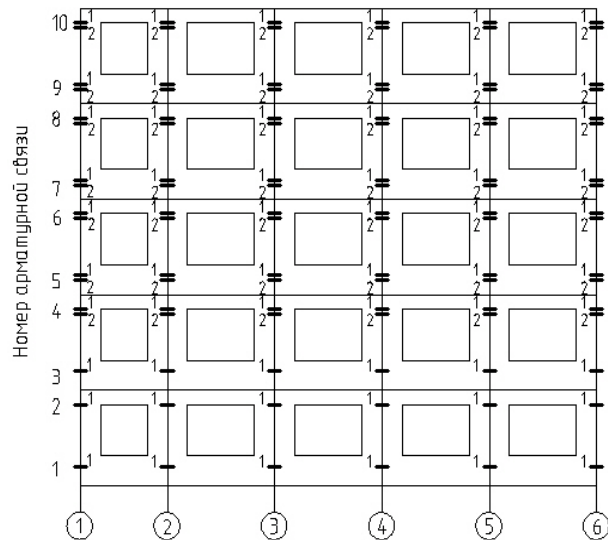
Схема фасада здания серии 1-480 с арматурными связями узловых соединений и элементами усиления при коррозии арматурных связей на 50%. 1 – арматурные связи; 2 – элементы усиления / The scheme of the facade series 480 with steel ties nodal connections and reinforcements from corrosion of reinforcing ties 50%
